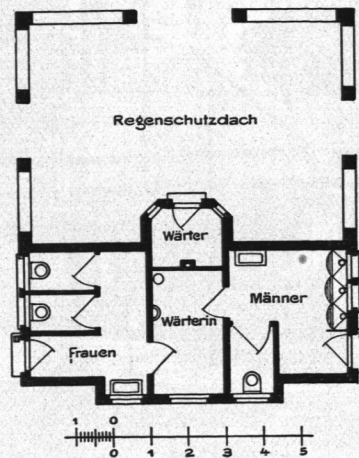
Bedürfnisanstalt mit Regenschutzdach in den Grünanlagen im Eilbecktal, Grundriß.
